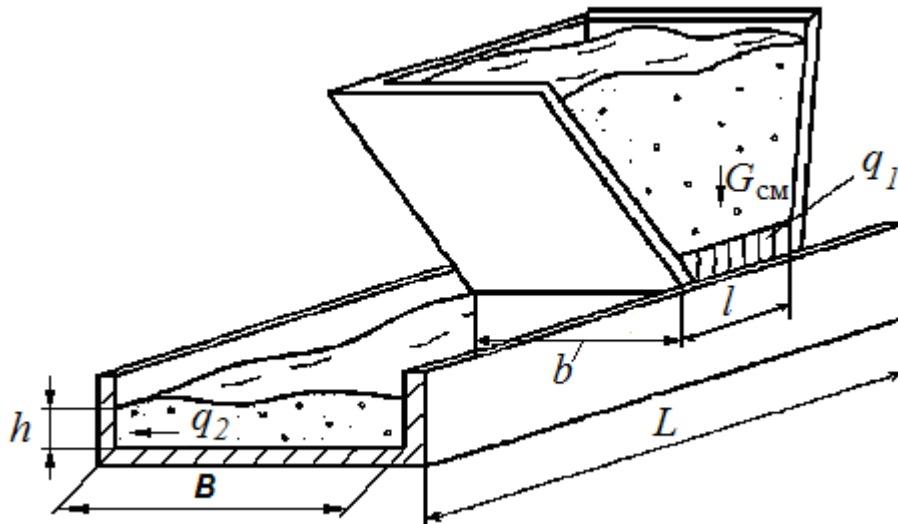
Схема к расчету ленточного питателя бетоноукладчика
